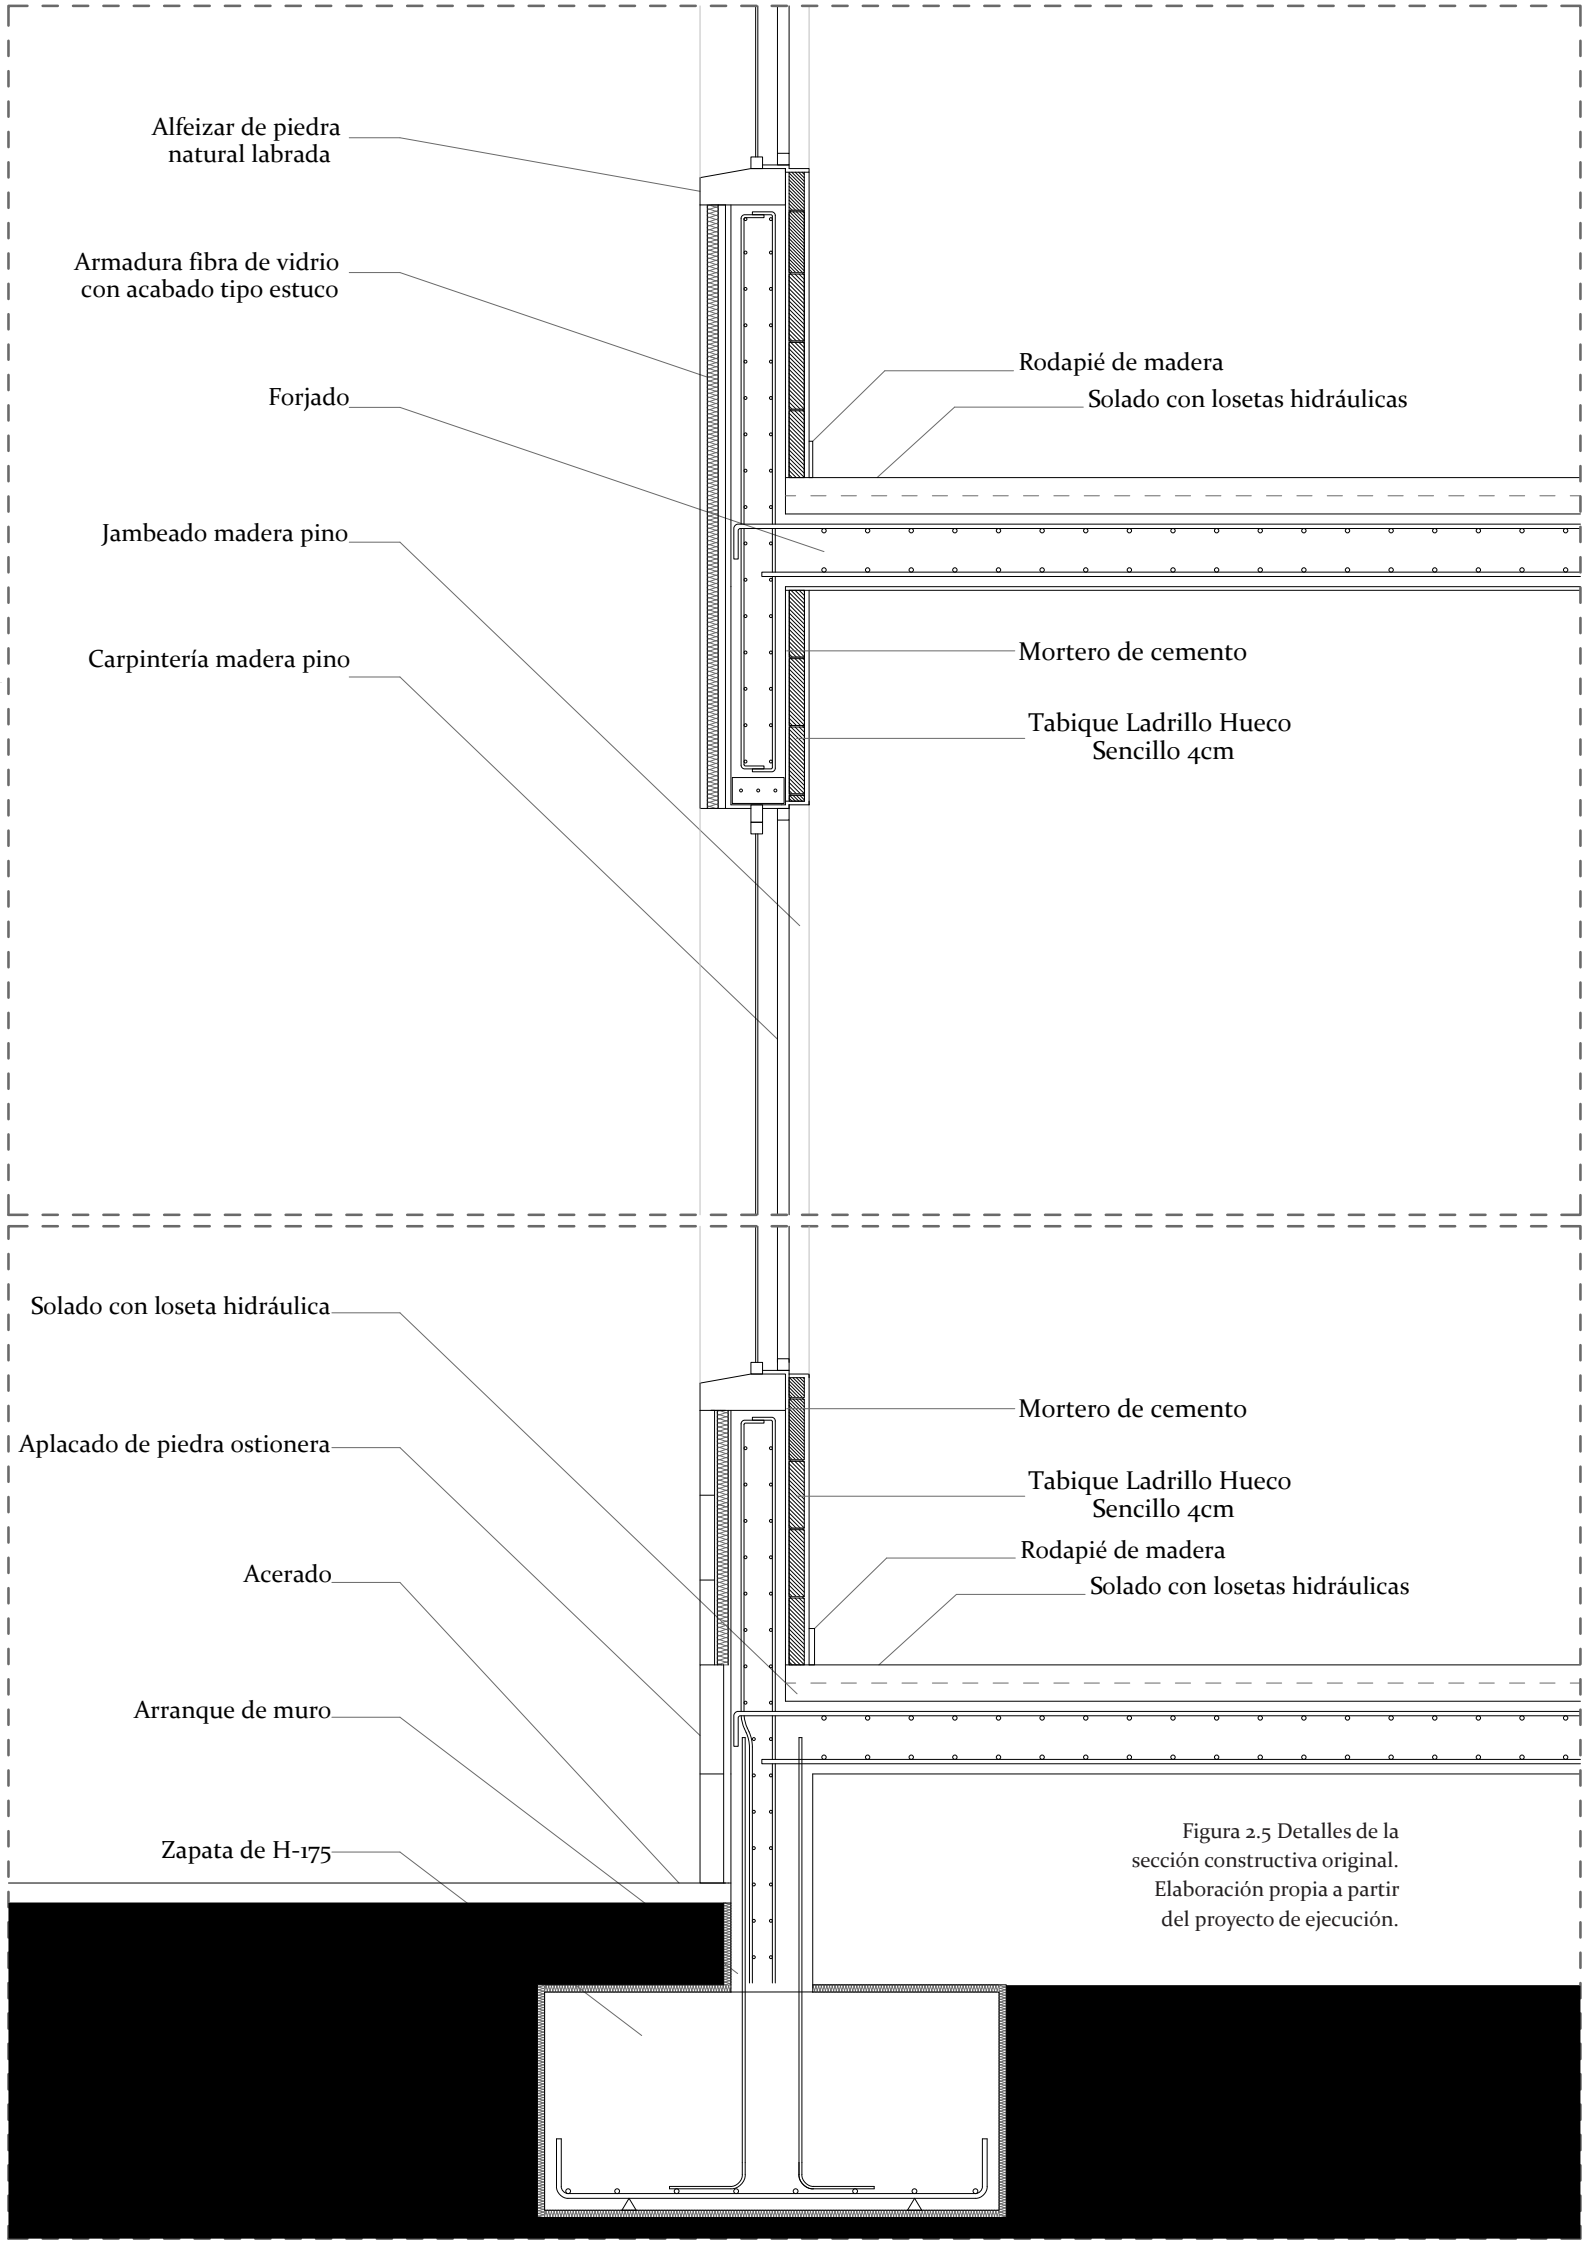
Detalles de la sección constructiva original. Elaboración propia a partir del proyecto de ejecución.
